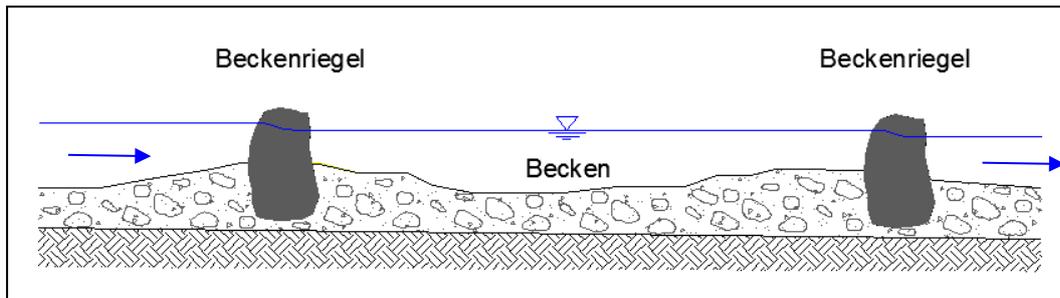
Prinzipdarstellung Raugerinne mit Beckenstruktur – Längsschnitt (Auszug)
